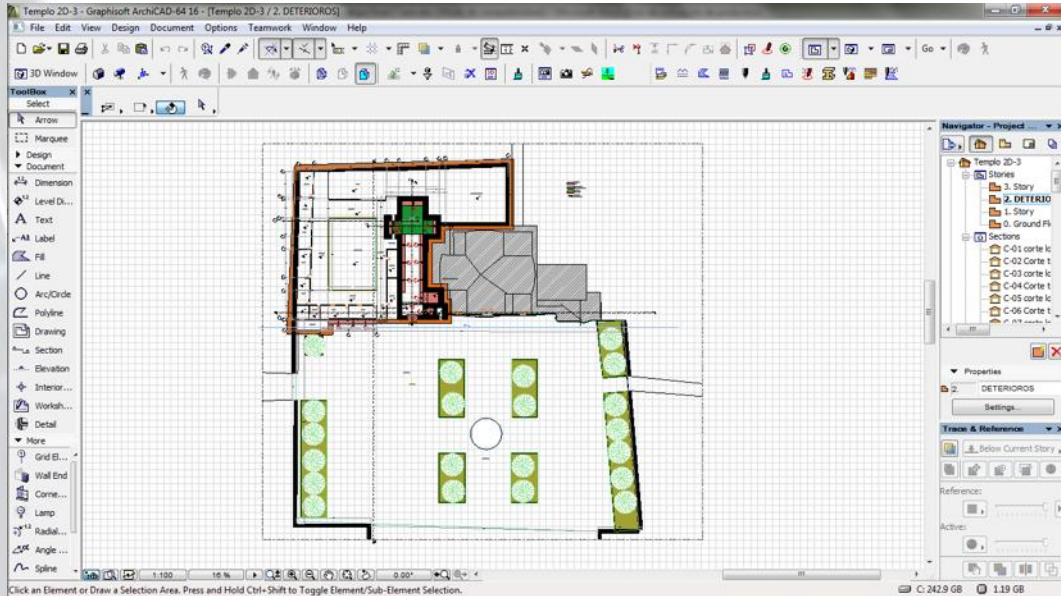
Elaboración de planimetría en ArchiCAD 16.
